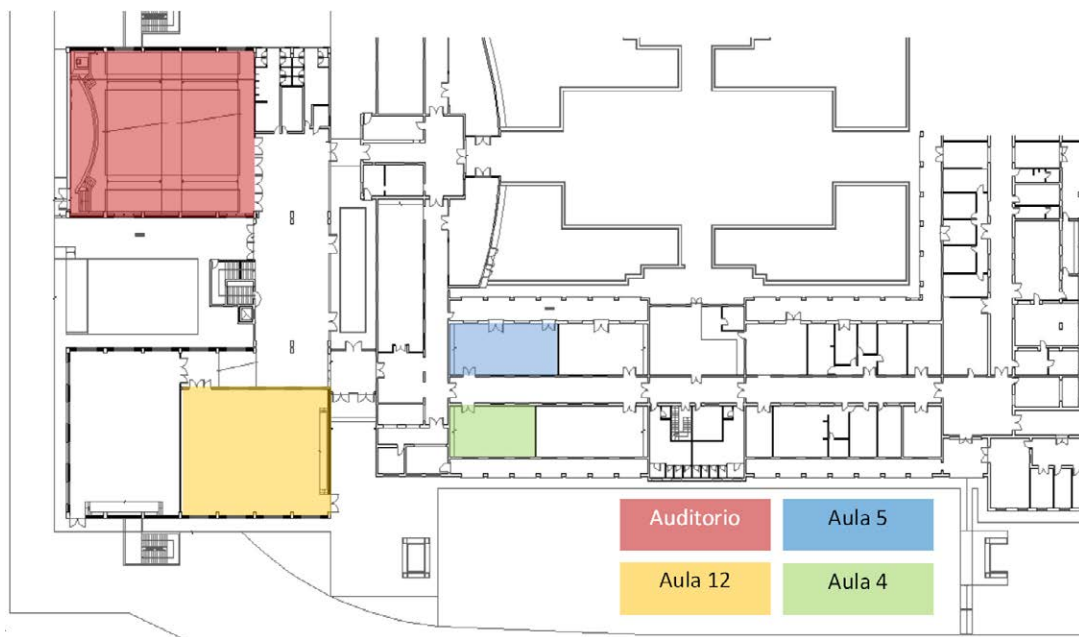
Ubicación de los locales para monitorear: planta baja, FAU-UNNE
